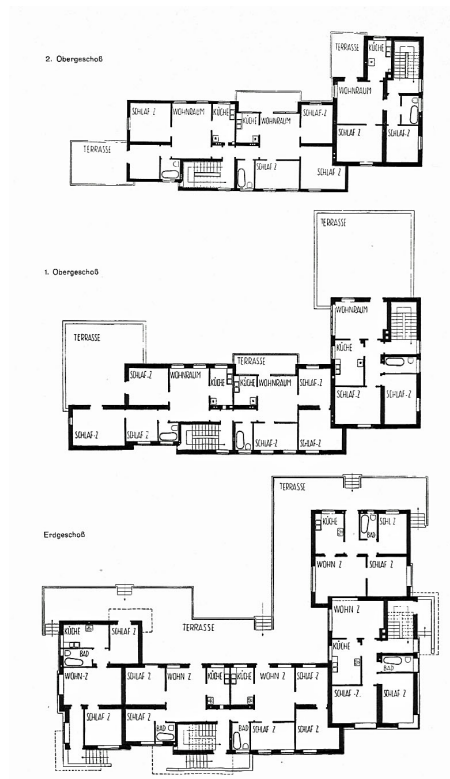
P. Behrens, *Terrassenhaus Grundrisse 1-3. OG*, Stuttgart 1927
